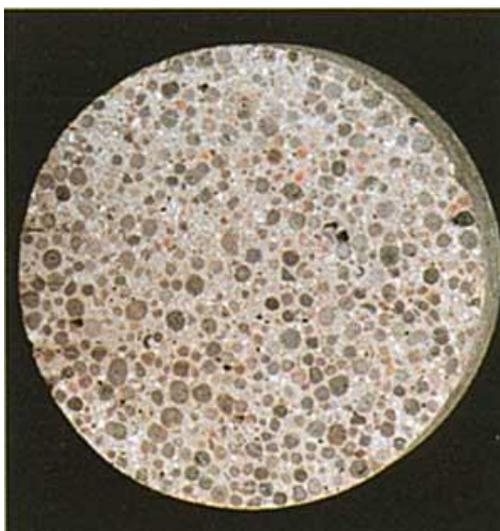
Sección de una probeta de hormigón ligero con árido de arcilla expandida. Fuente: Internet
